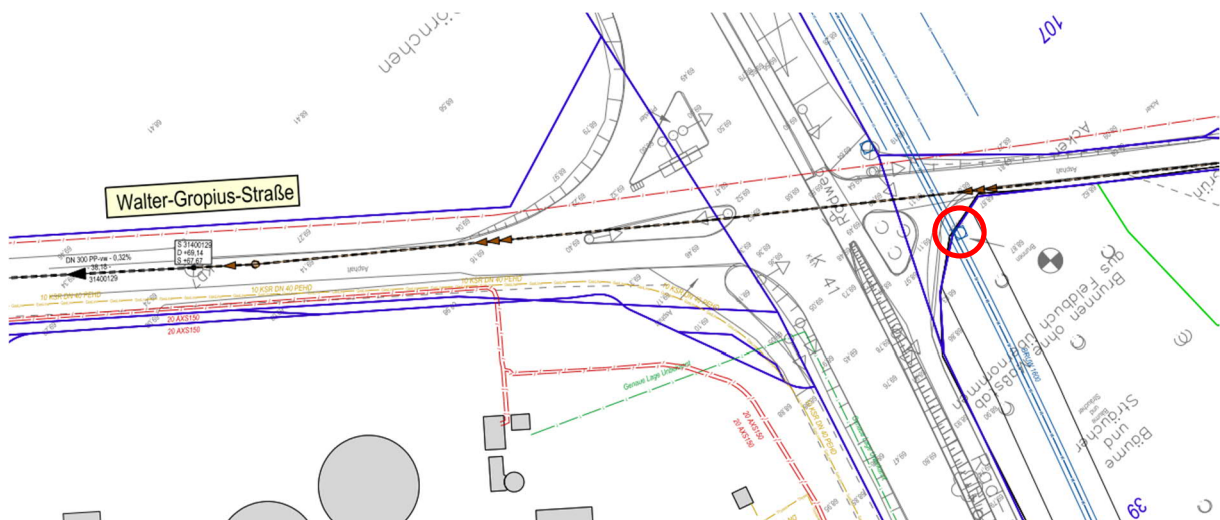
Ausschnitt aus dem Übersichtslageplan, Stelle der Suchgrabung in rot markiert.
